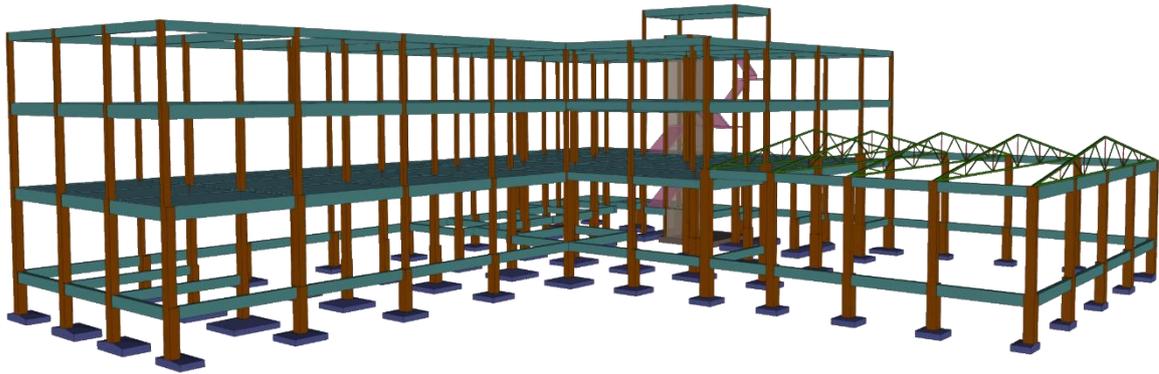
Proyecto ejecutivo: estructura 3D extraída de CYPECAD.
